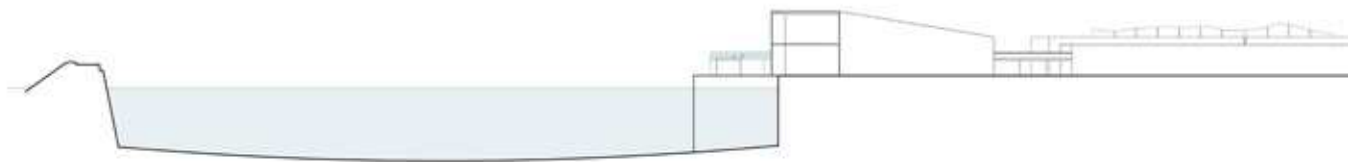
CORTE DA PROPOSTA ELABORADA PARA A ZONA TERMINAL DE PASSAGEIROS
